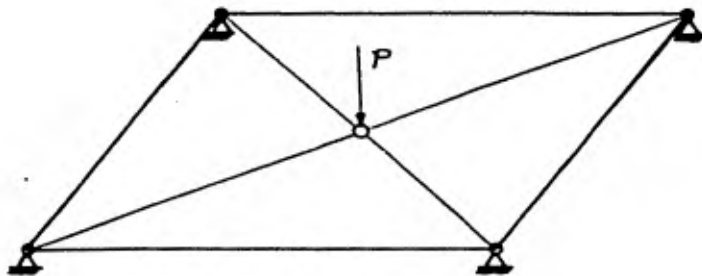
NUDO PLANO - CONFIGURACION INESTABLE
